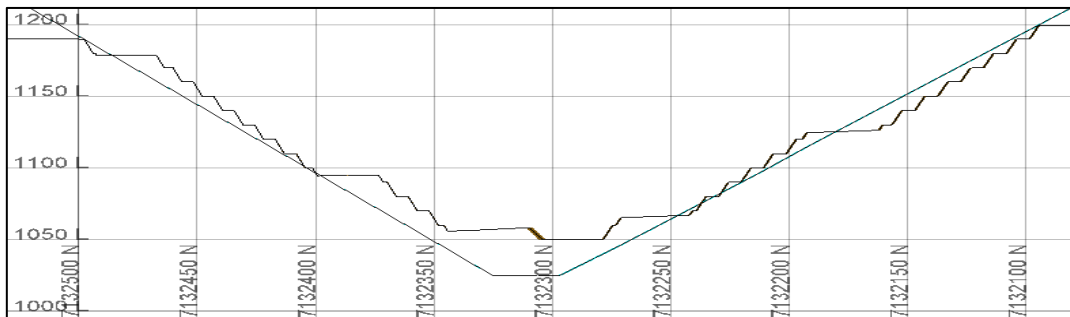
LPNB Fase 1 - Vista en sección - Corte principal N-S E394100
